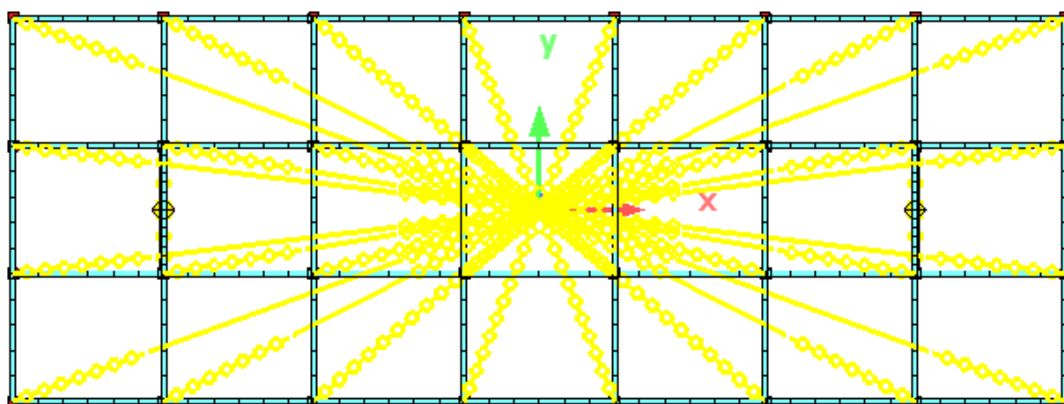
Planta esquemática dos pavimentos com diafragmas.
